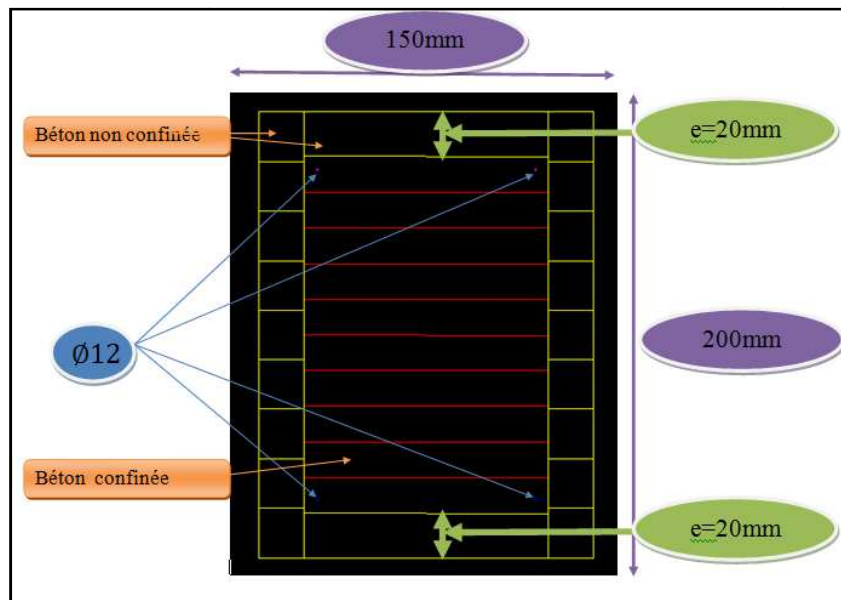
La coupe longitudinale de ferrailage pour la poutre 2
